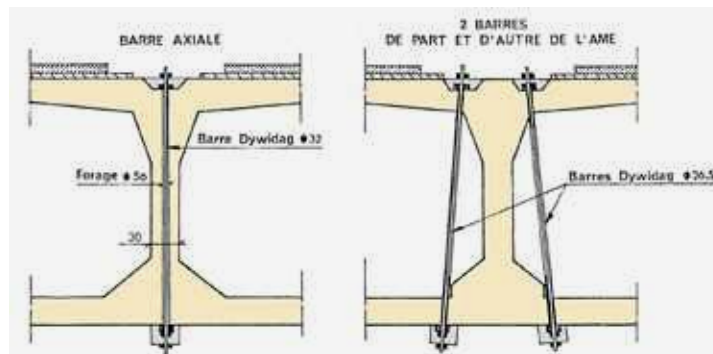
principes de renforcement de l'âme d'une poutre-caisson par des barres de précontrainte internes et extérieures
